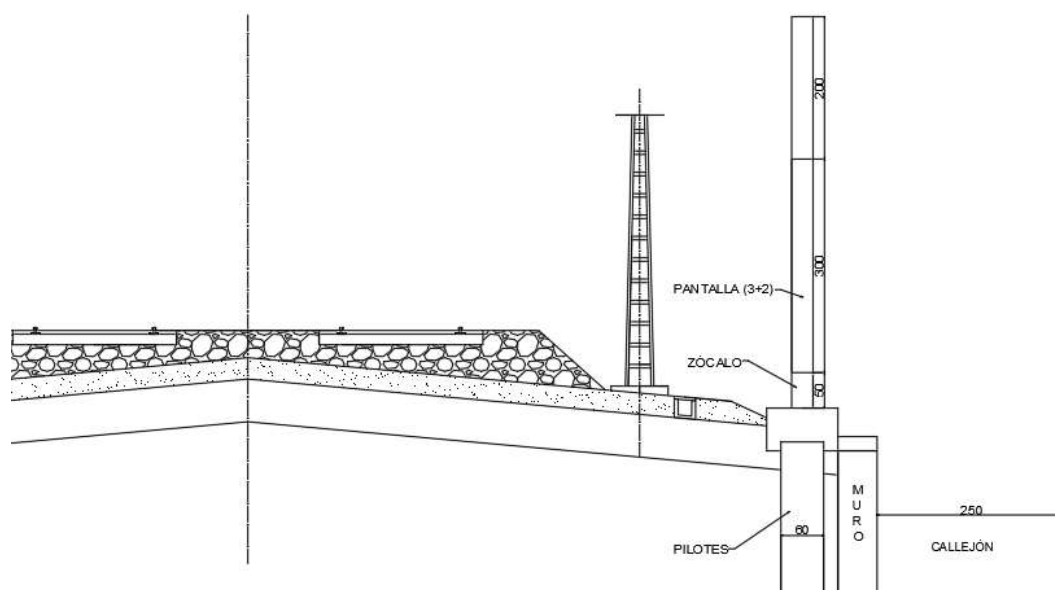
Alternativa 1. Cimentación mediante pilotes. Fuente: elaboración propia.
